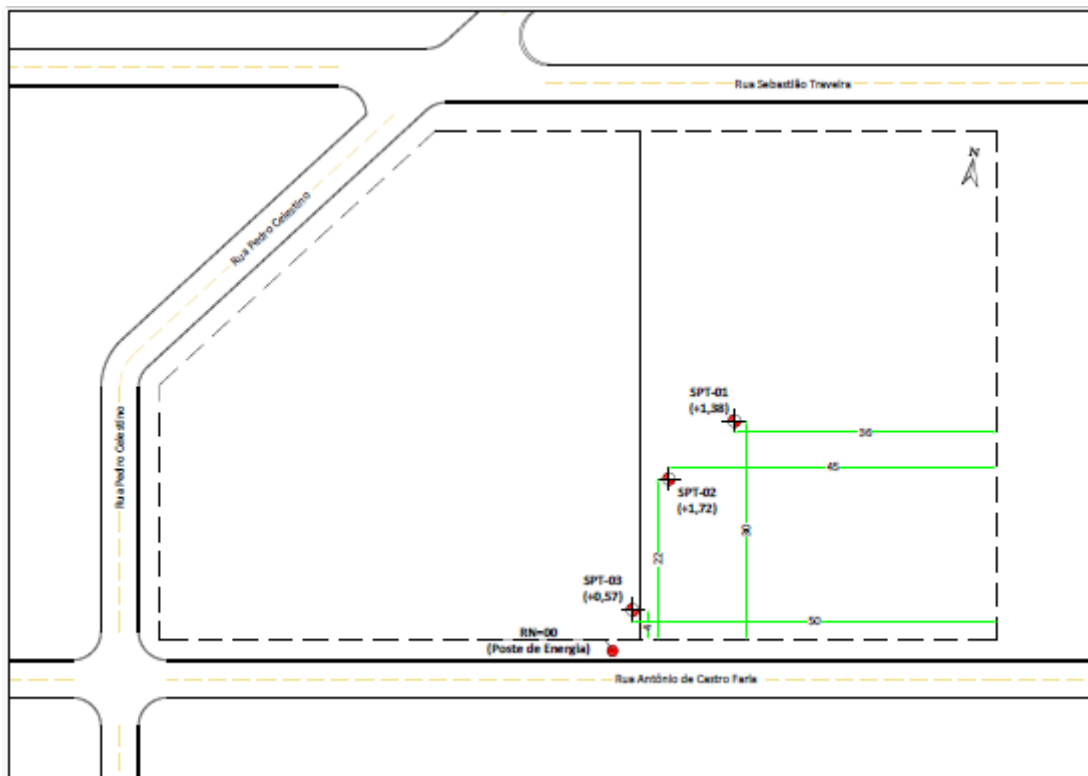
Croqui de locação dos furos de sondagem executados na área.
